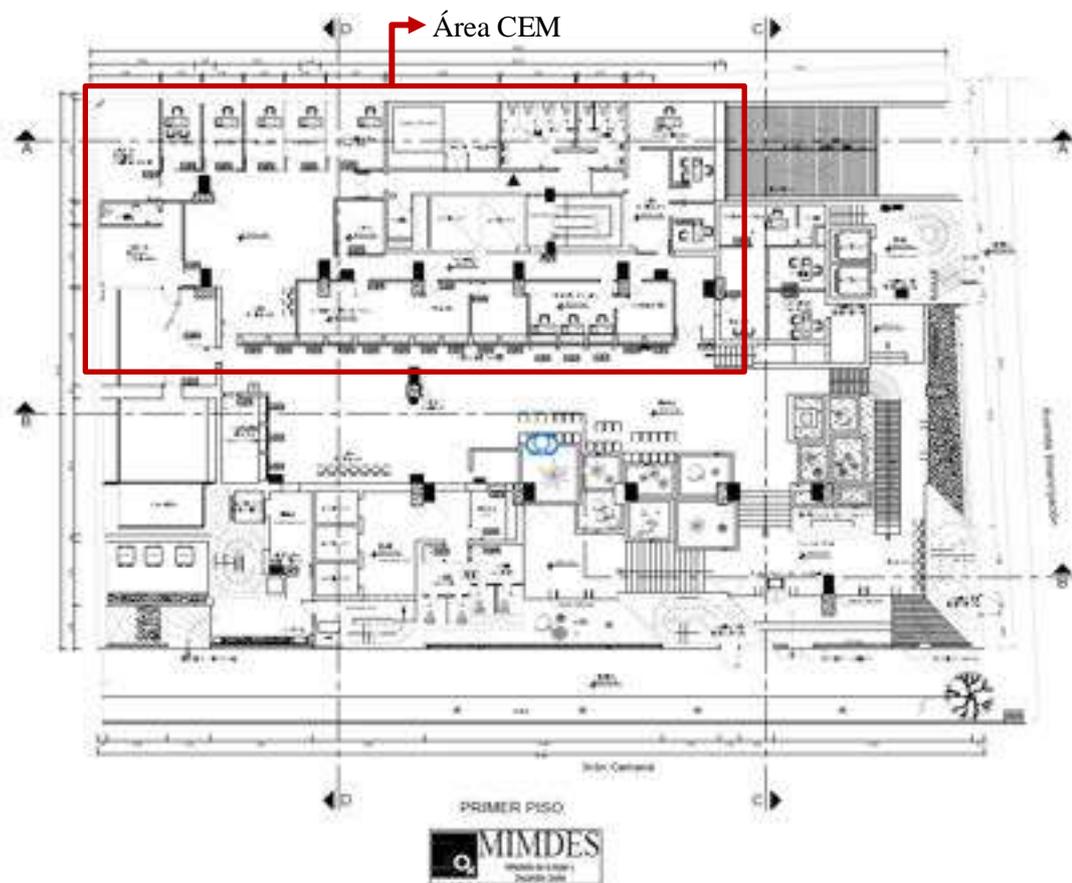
Plano Arquitectónico del Primer piso del MIMP – sede principal.
